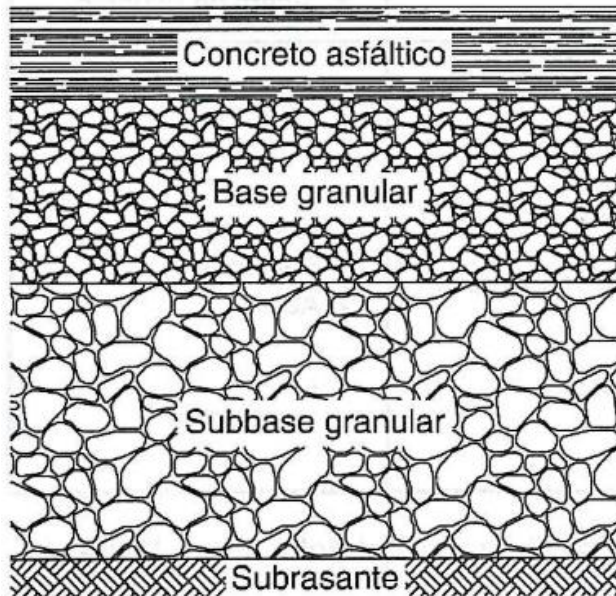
Corte transversal convencional de una estructura de pavimento flexible. Fuente: (Higuera Sandoval, 2011)
